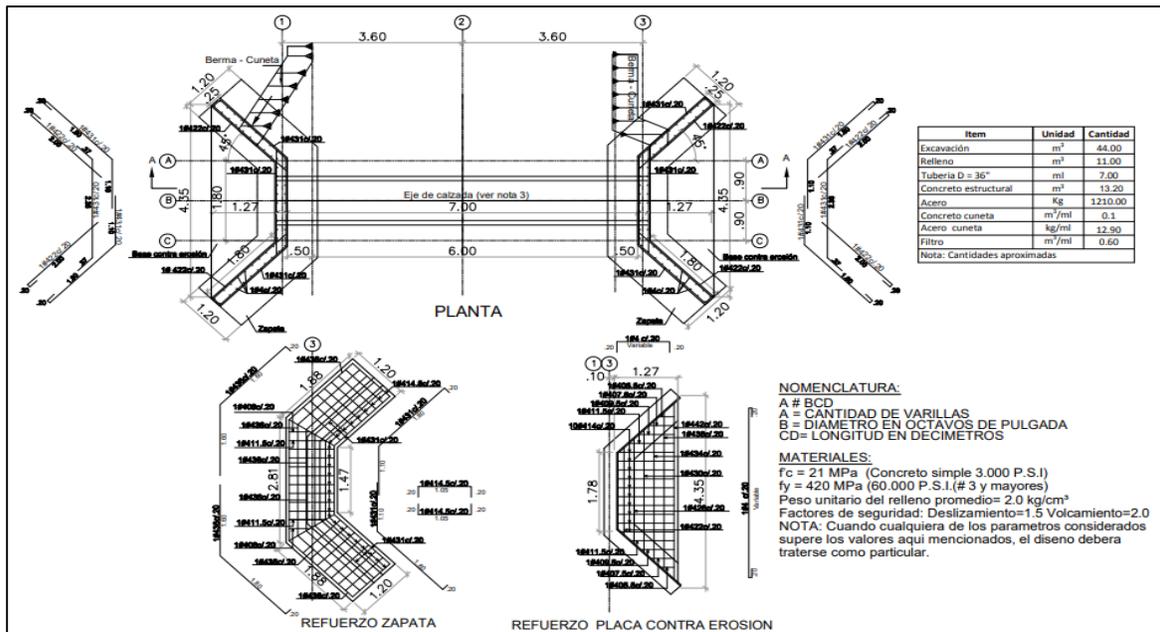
Detalle refuerzo Alcantarilla con muros en concreto reforzado Aleta – Aleta.
